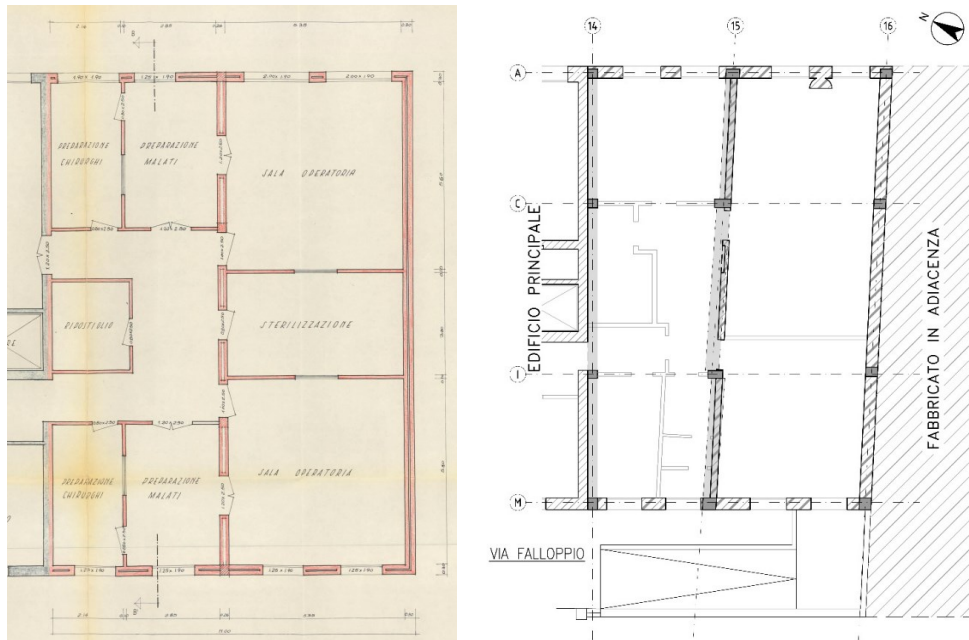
Pianta Piano Terra – Confronto elaborato di progetto del 1967 – stato attuale
